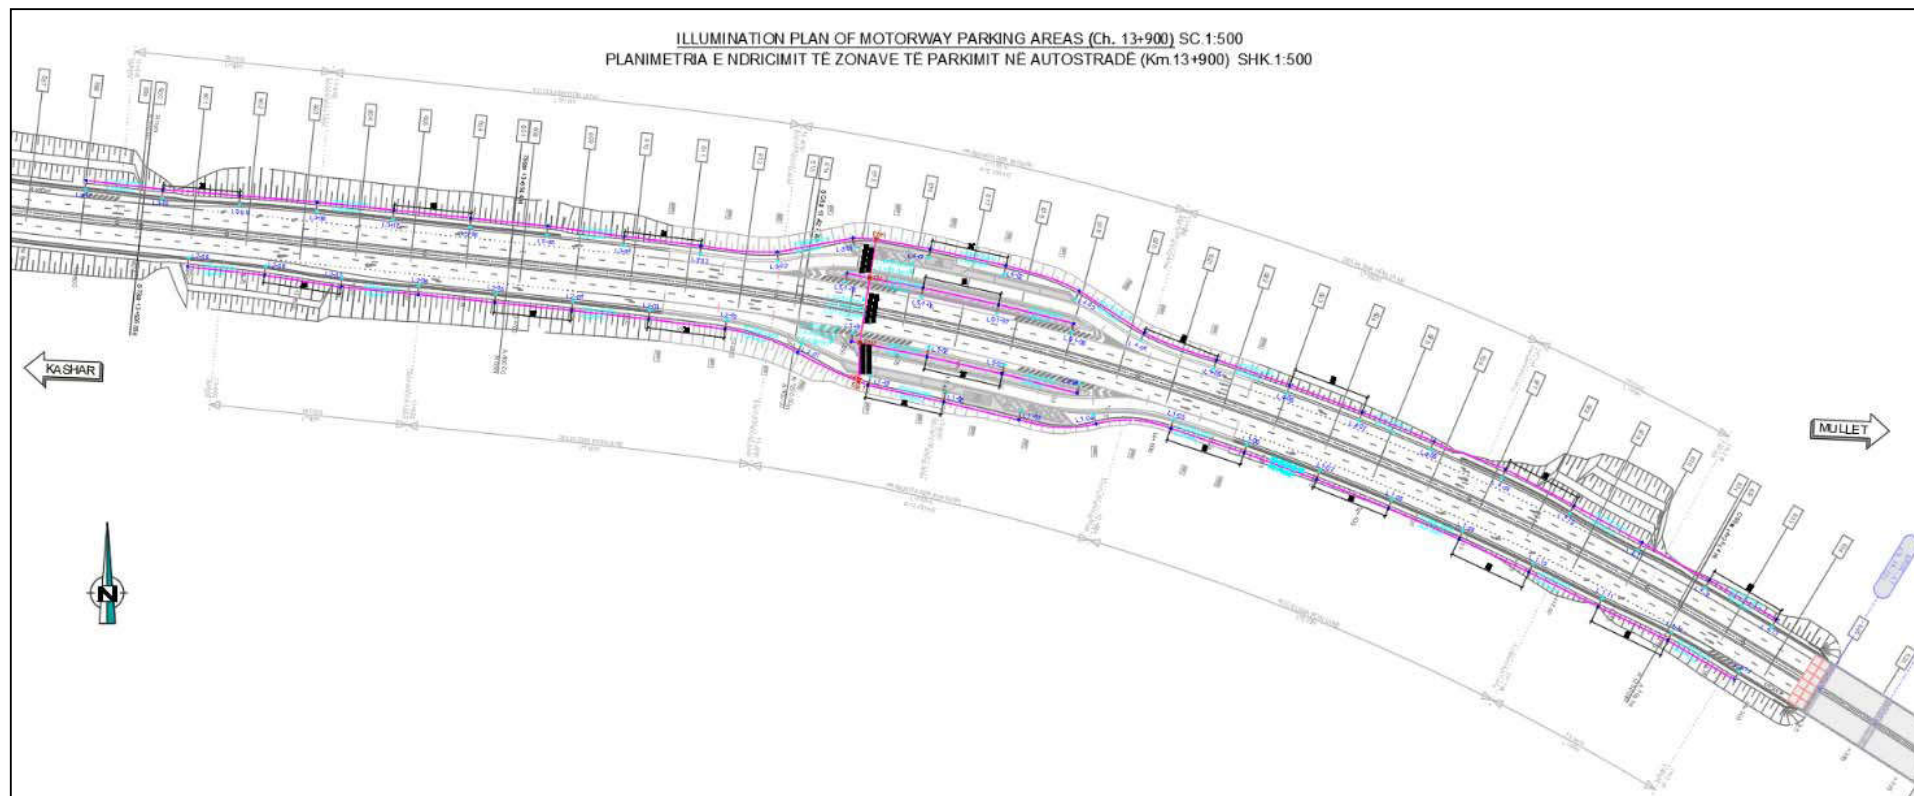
Plani i ndriçimit të zonës së parkimit në autostradë
